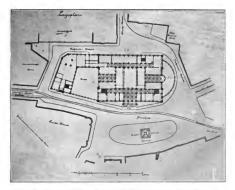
Lageplan des Postgebäudes an der Domshaide.
